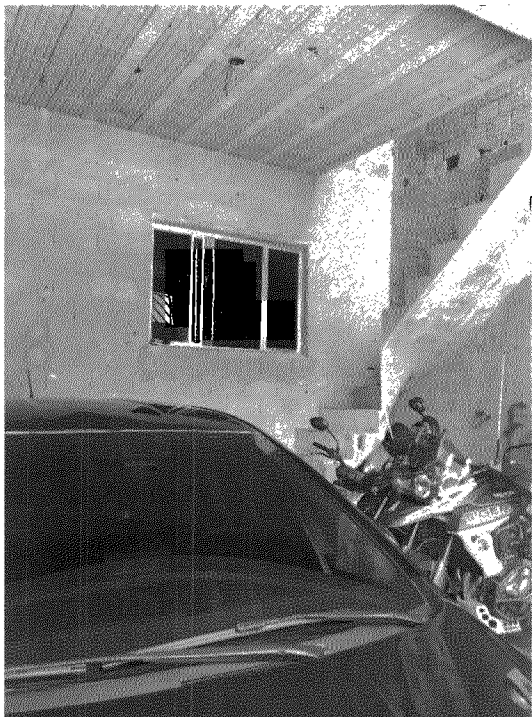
VISTA INTERNA PÓS PORTÃO GARAGEM
